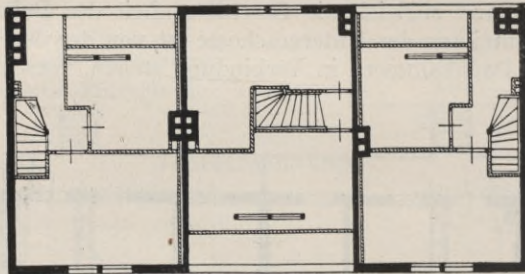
Grundriß Dachgeschoß zu Abb. 43.
